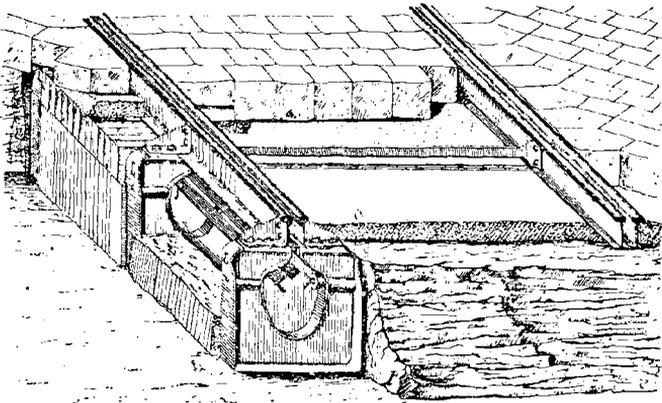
Caniveau de Budapest. — Coupe en voie courante.
